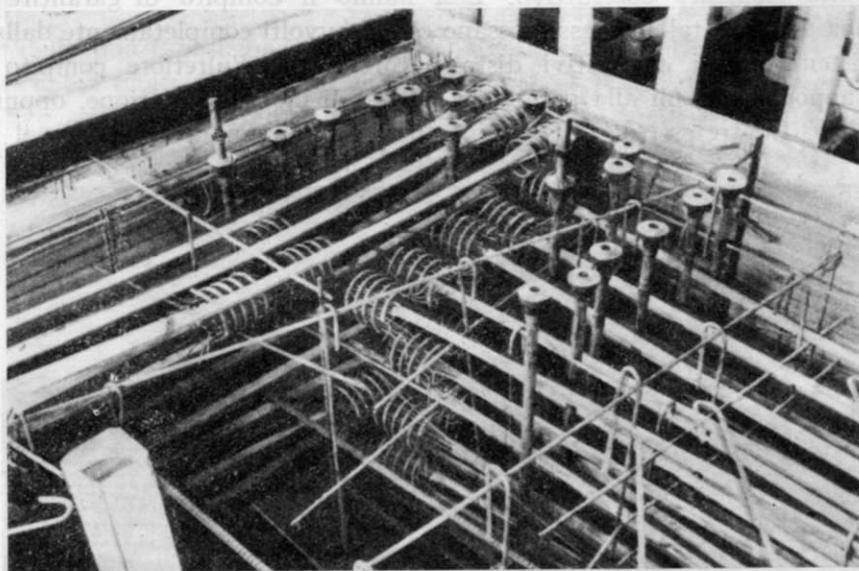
Centrale termica a vapore di Heilbronn. Fondazione delle turbine a vapore.
